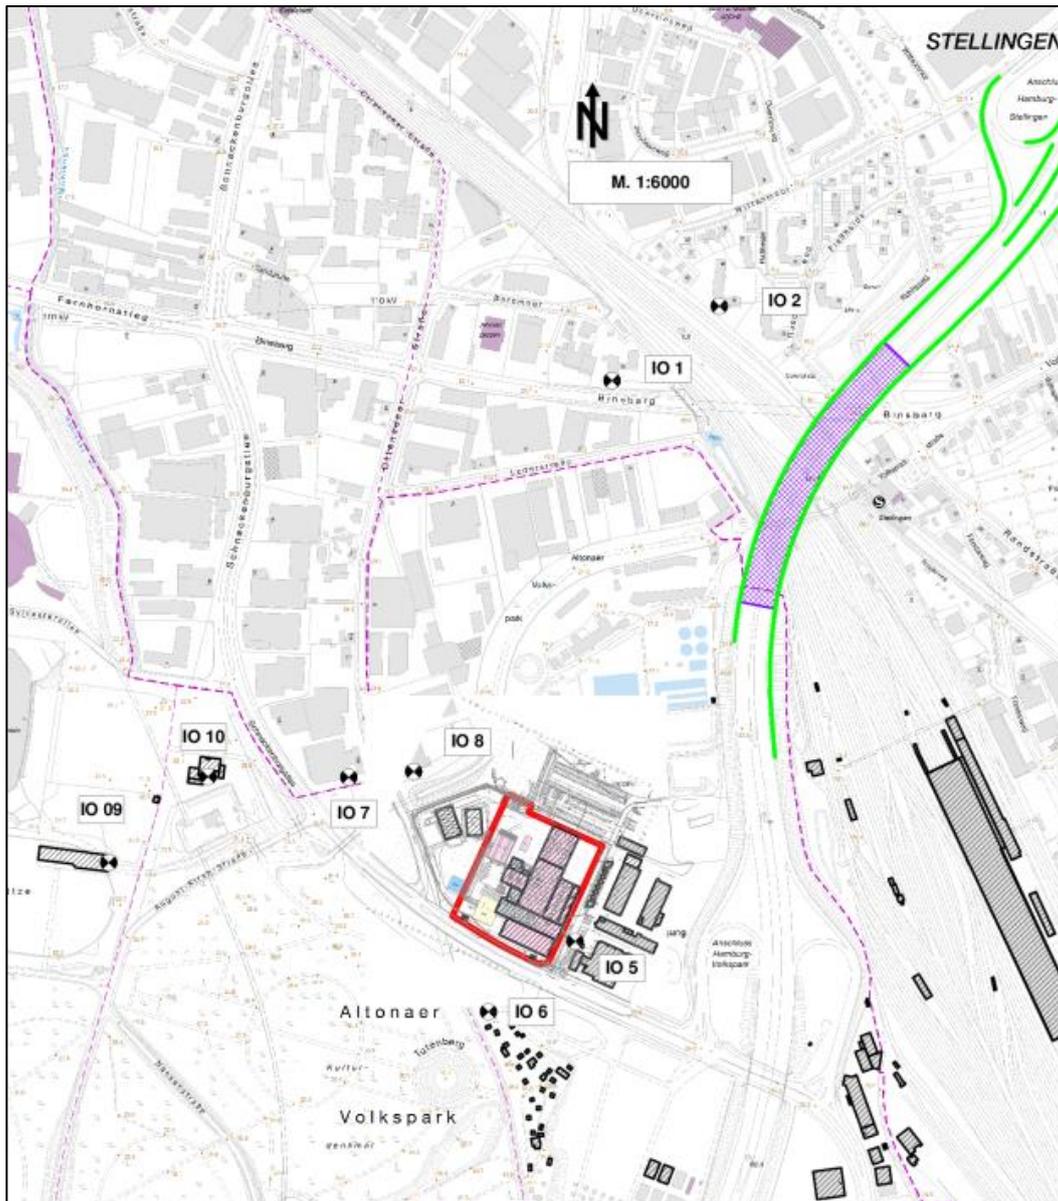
Übersicht Immissionsorte (Ausschnitt Lageplan IPRO Baulärm)
